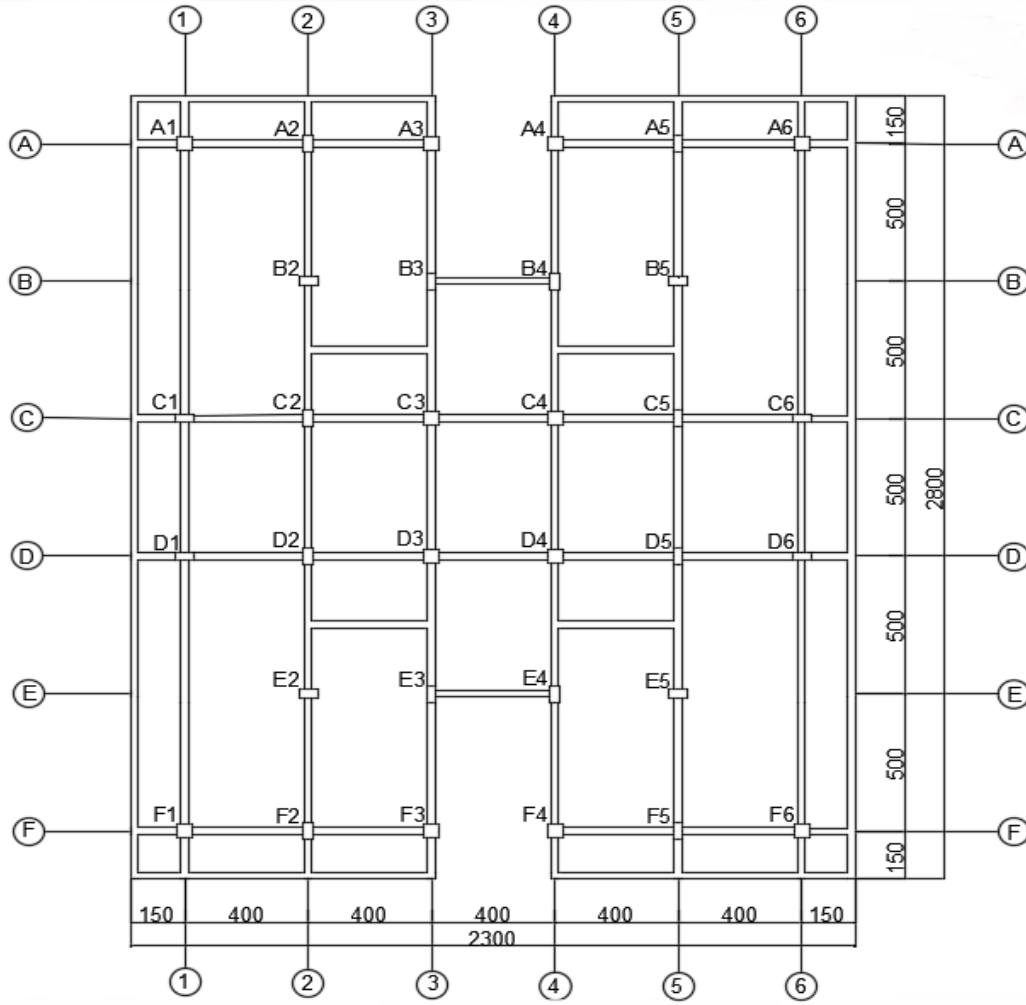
Taşıyıcı sistemin planda yerleşimi – Plan 2
